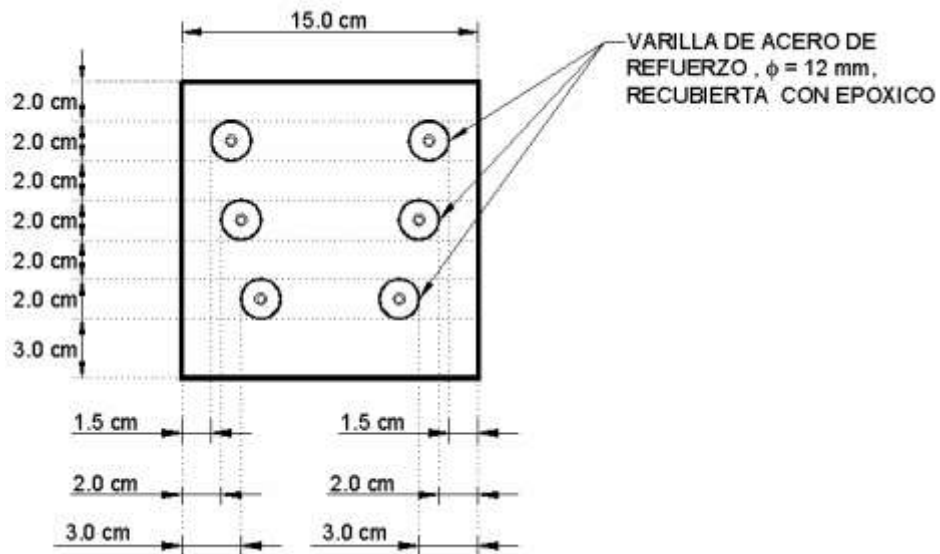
Detalle de la distribución del acero de refuerzo en los especímenes (López Celis et al., 2006).
